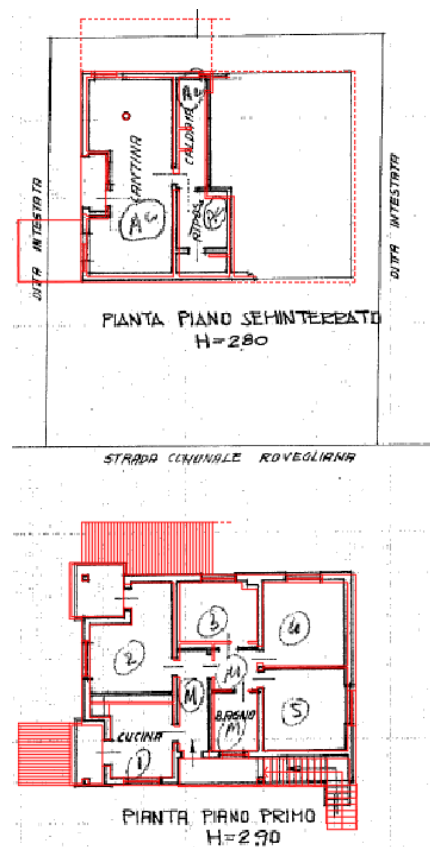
Sovrapposizione planimetria catastale con stato di fatto abitazione ([Allegato N.3](#))
